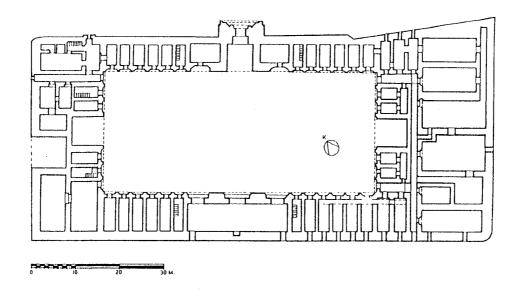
مسقط أفقي لجامع العاقولي ببغداد. • (عن: Ulucam).
